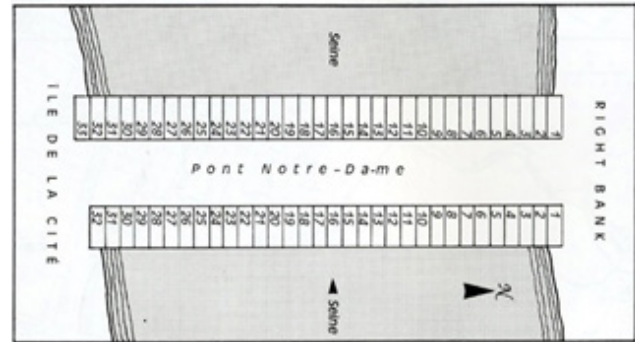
Planul construcțiilor de pe podul Notre Dame. Magazinele de la parter aveau parte de iluminat natural generos grație vitrinelor mari, dar și a ferestrelor adăugate ulterior pe fațadele orientate către Sena./Construction plan for Notre Dame Bridge. The shops on the ground floor had generous natural lighting thanks to large windows, but also because of the windows added later on the facades facing the Seine.
